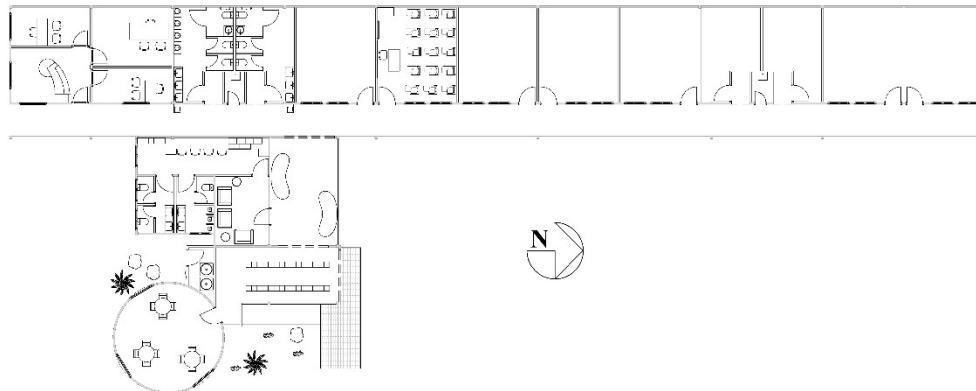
Planta Edificio 1, Zona 1, sin escala.
